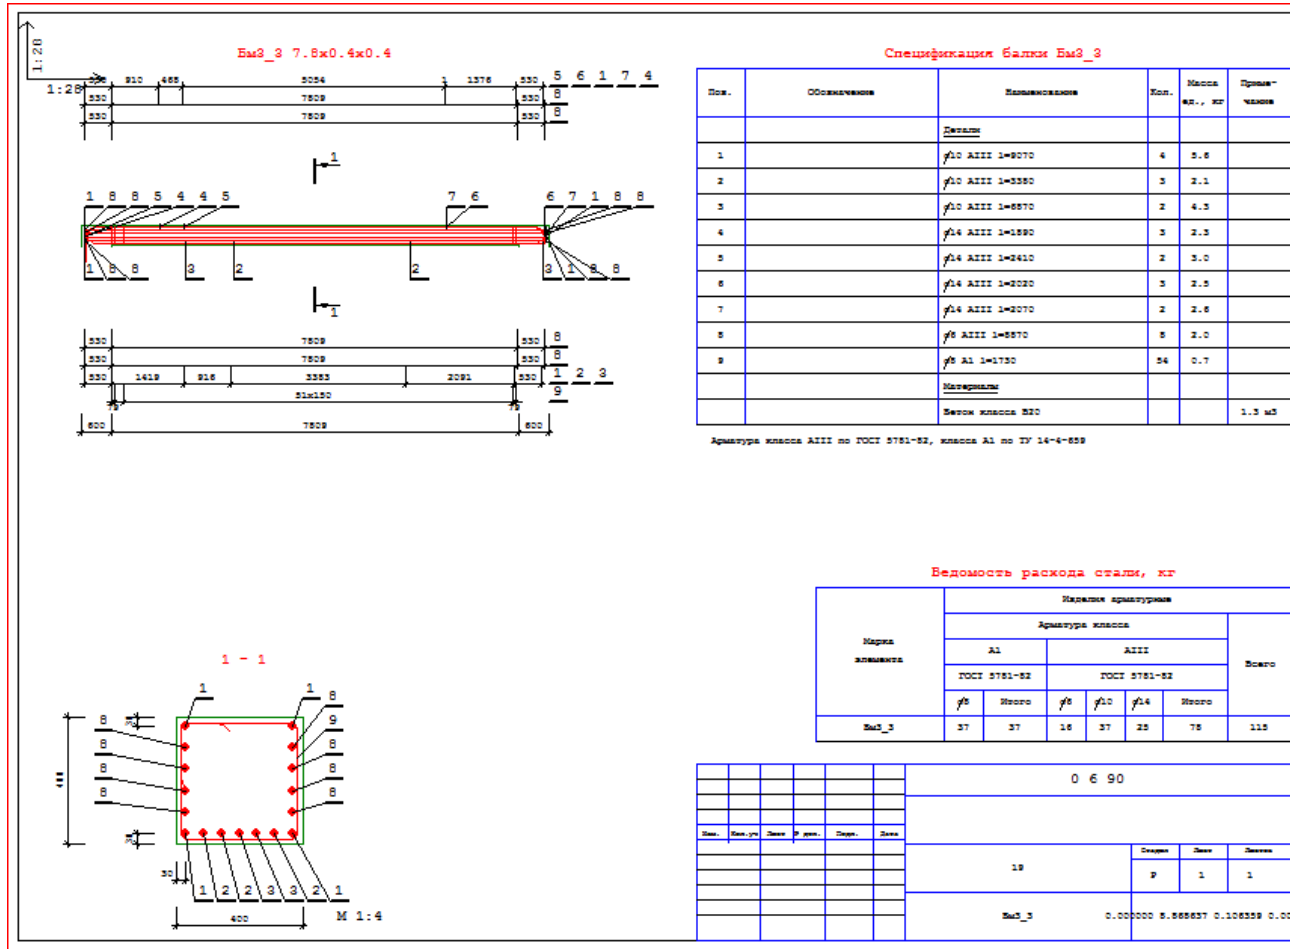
Вариант балково-плитного перекрытия. Балка БЗ-3. Кресления рабочего проекта
